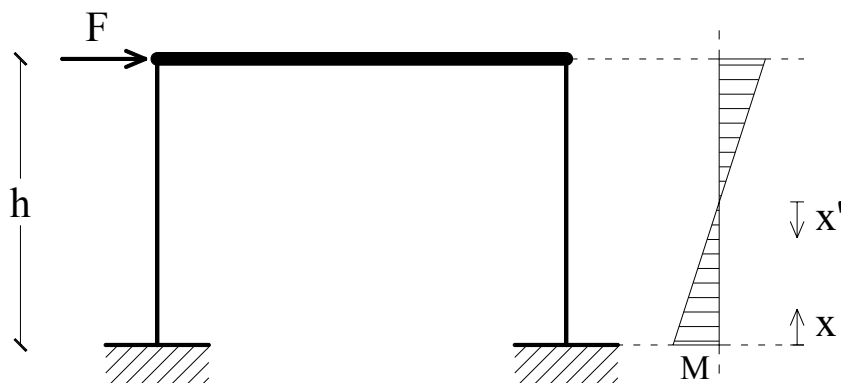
Schema statico a telaio Shear-Type dei pilastri.
